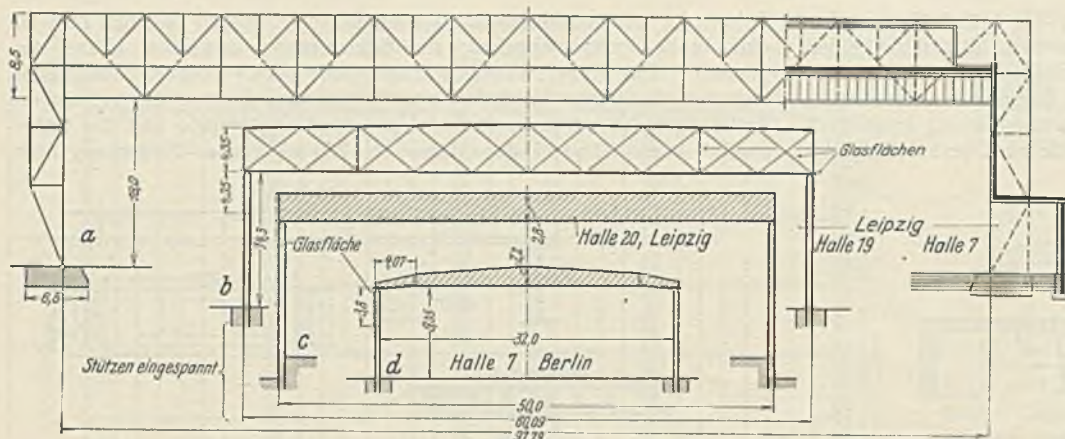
Hallenbauten in Balkenform, maßstäblich zusammengestellt, von der Berliner Halle VII (Holzlehrschau) beginnend und mit der gewaltigen, mehr als dreimal so weit gespannten Halle 7 in Leipzig endigend.
